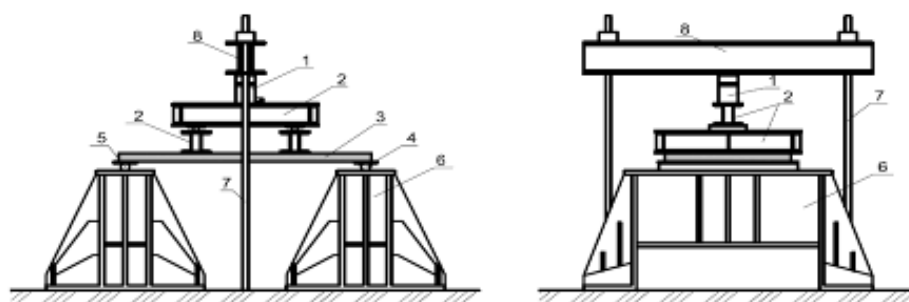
Стенд для випробування залізобетонних плит незнімної опалубки
